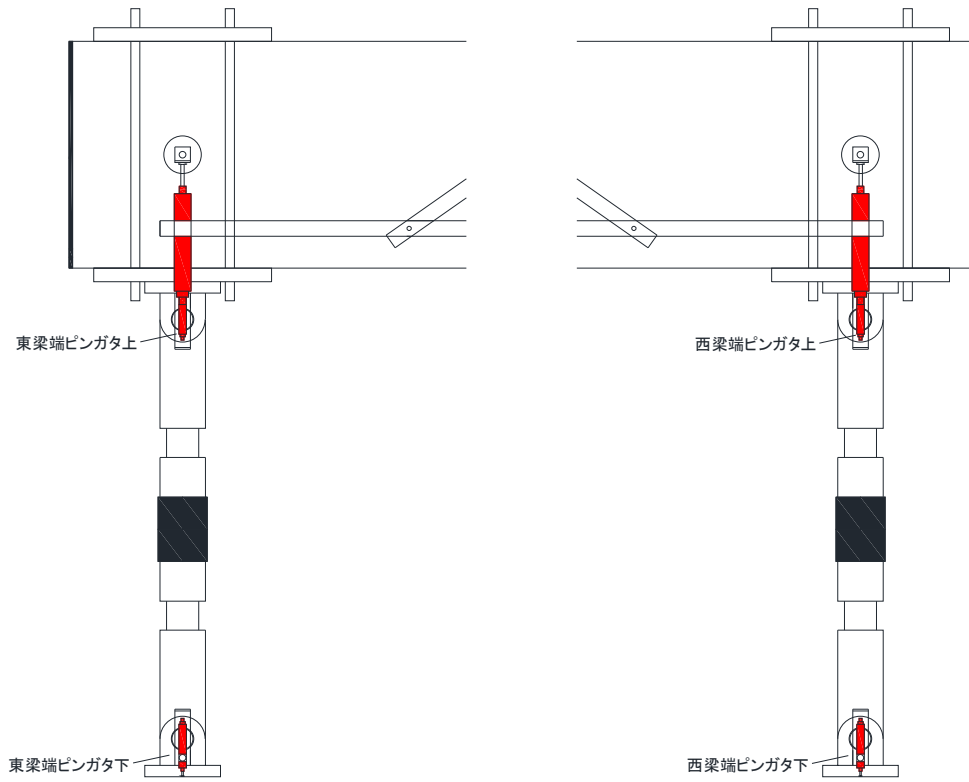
DR-5 基礎梁端変位計治具図面
